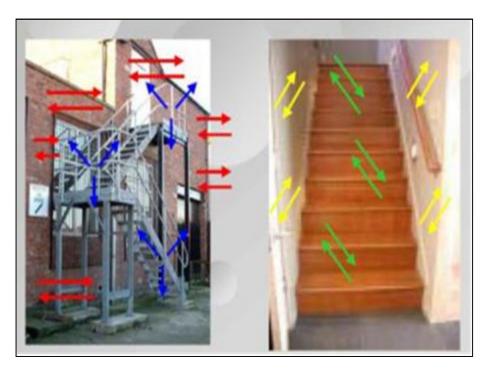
Disposición de escaleras Fuente (JOMY, 2008)
